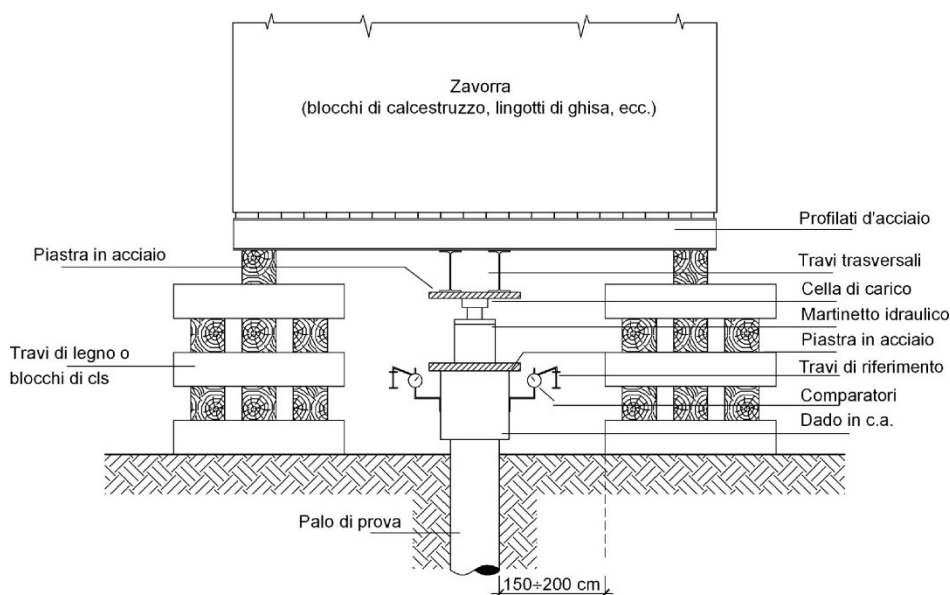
1 - Schema di applicazione del carico di prova su palo di fondazione con cassone zavorrato
